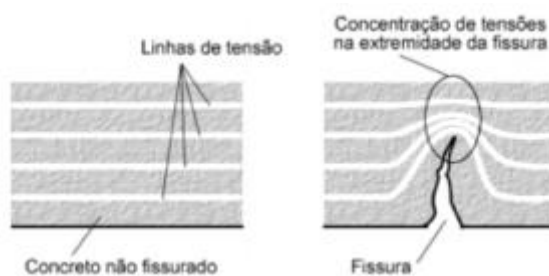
Propagação de fissuras em concreto simples (Fonte: Barros, 2009, apud Do Nascimento, 2015).
